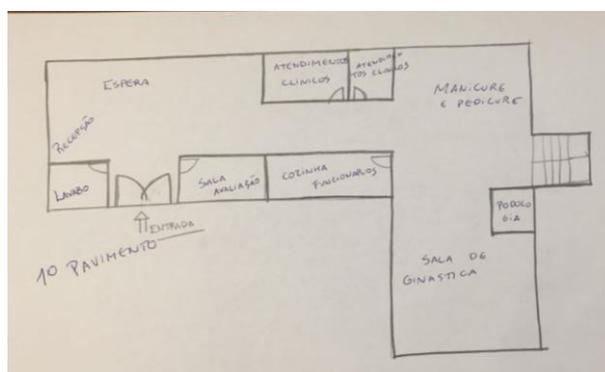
Croqui esquemático da planta baixa do 1º pavimento do Santé Spa.
